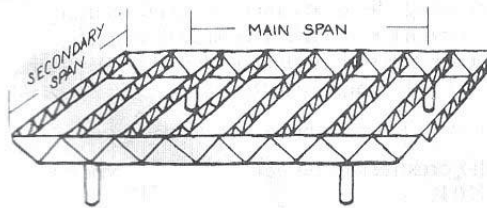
Sub-Struktur Horizontal – Slab & Beam
